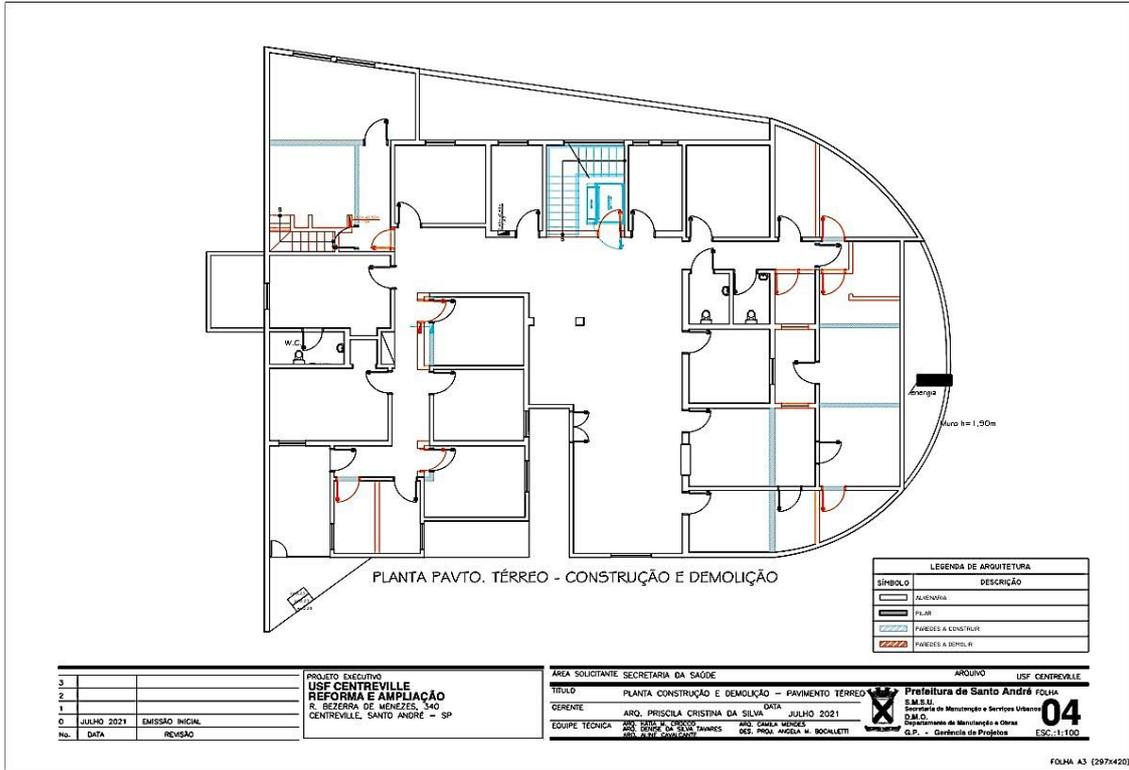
US Centreville. Planta do pavimento térreo, mostrando em vermelho a área será removida e em azul a que será construída.
